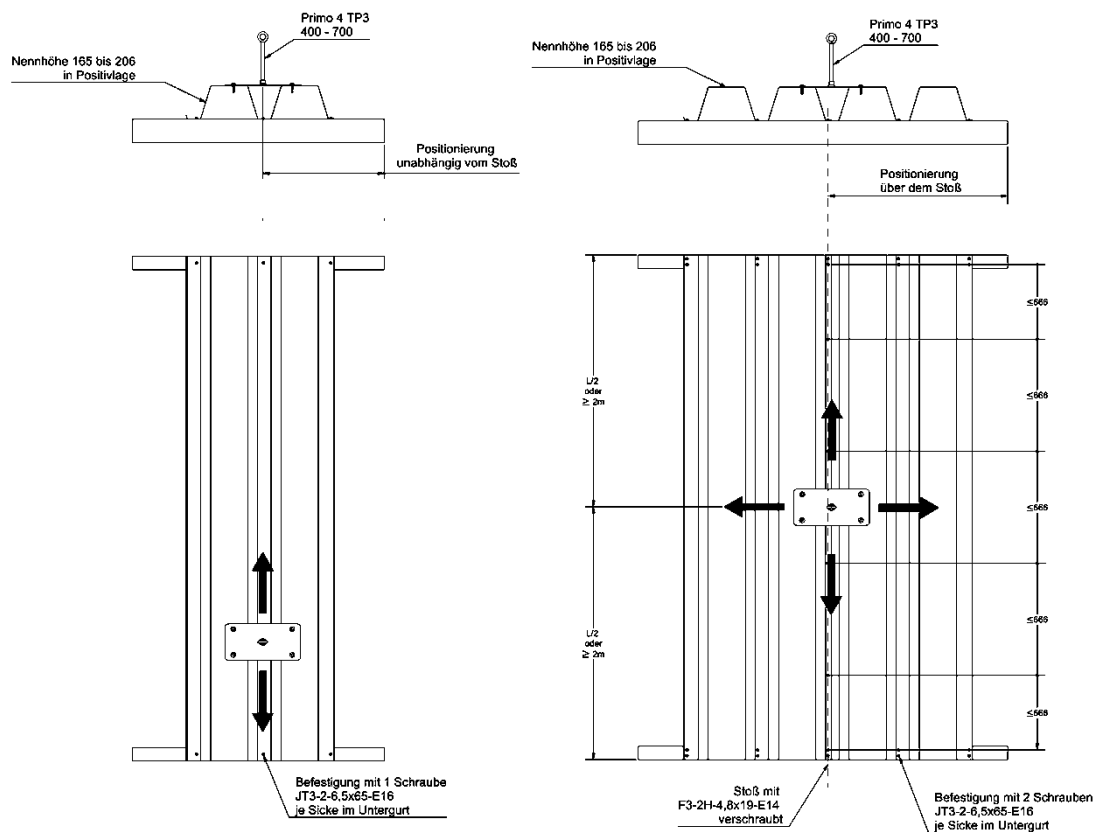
Primo 4 TP3, Variante D: Positivlage, Befestigung im anliegenden Gurt (siehe Zeichnung mit 1 oder 2 Schrauben), Profilhöhen 165 bis 206 mm, Blechdicke 0,75mm
